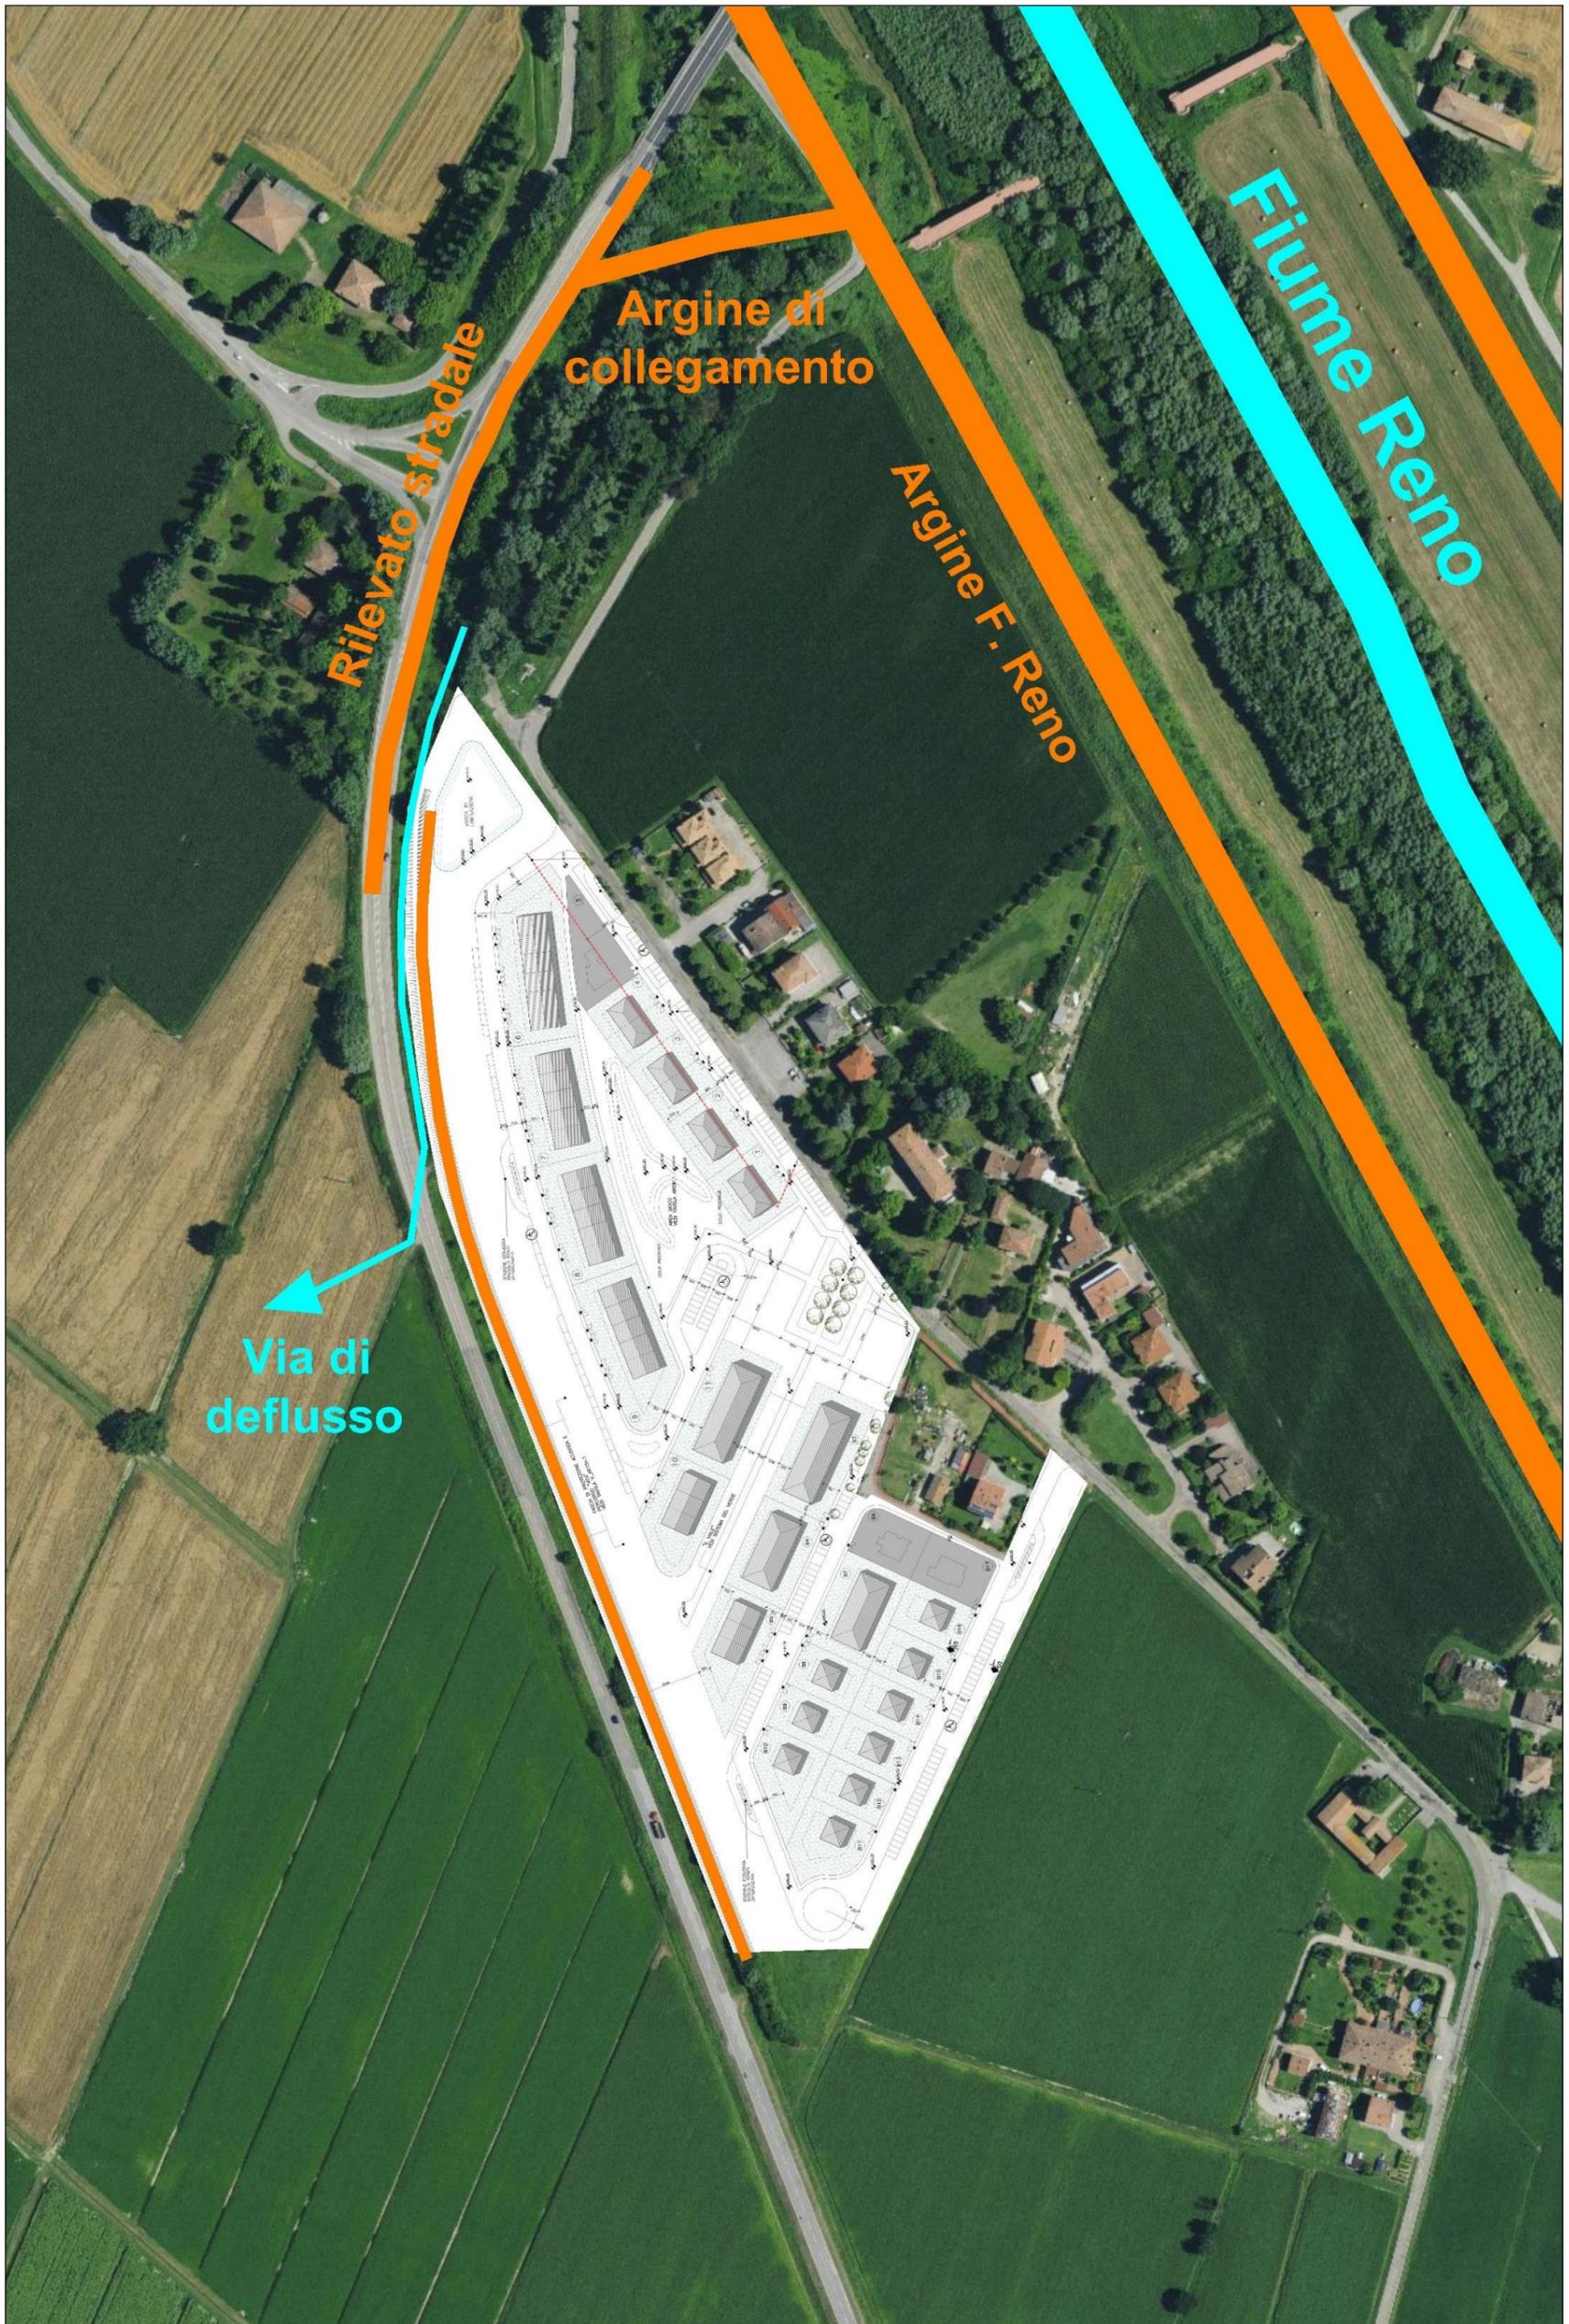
Planimetria di dettaglio degli elementi di valutazione del rischio idraulico (su fotografia aerea tratta dal sito DBTR – 2018)
